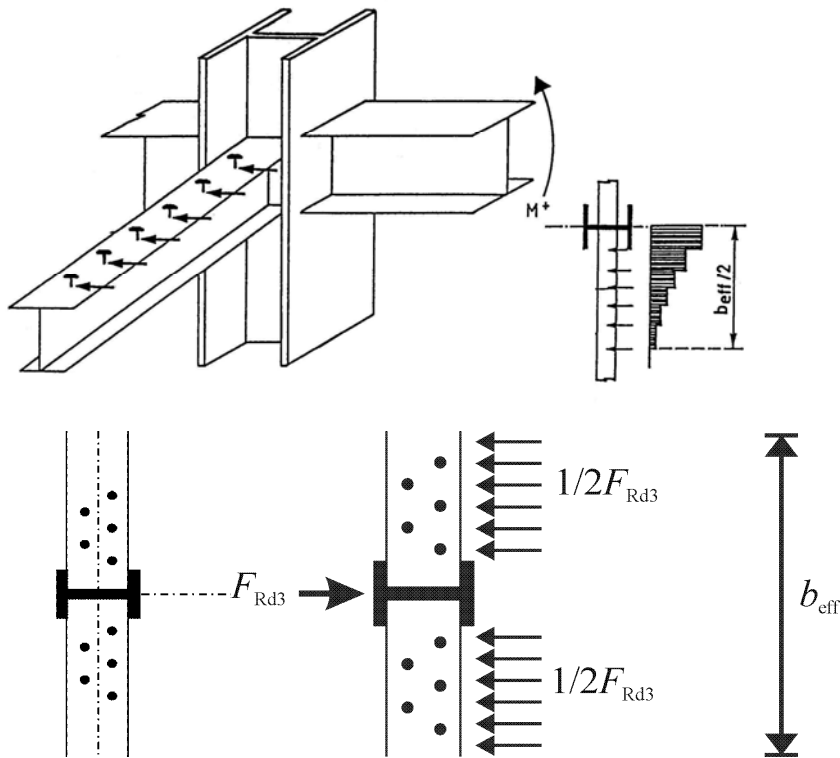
Mécanisme 3 : la compression en dehors du poteau reprise par les connecteurs d'une poutre de façade en acier.
